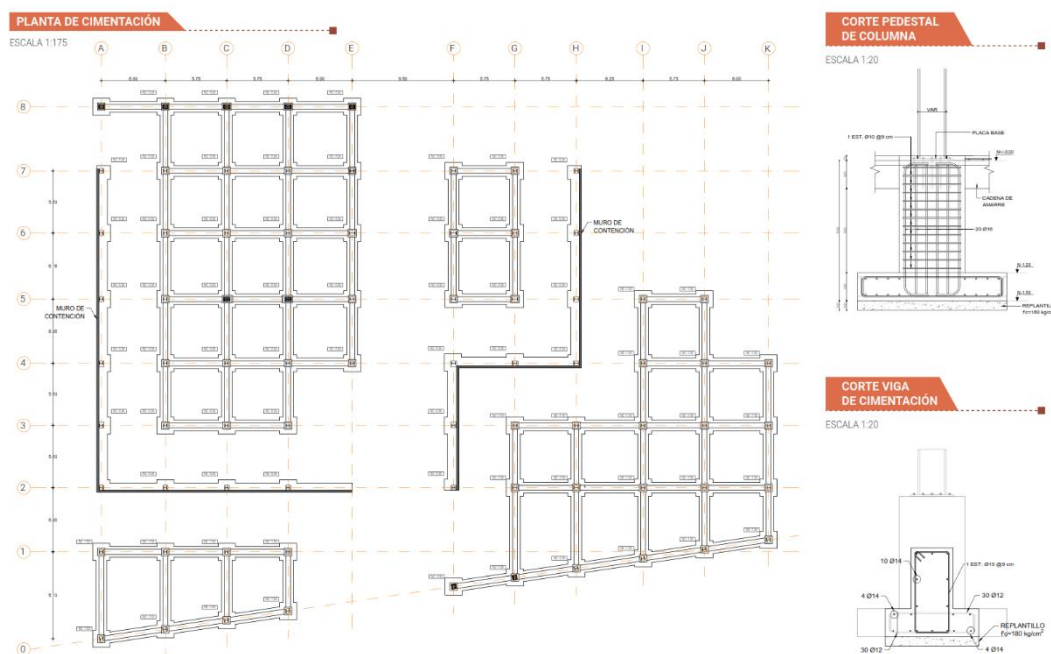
Planta de cimentación y detalle de pedestal y viga de cimentación (Gualavisí N., 2022)
